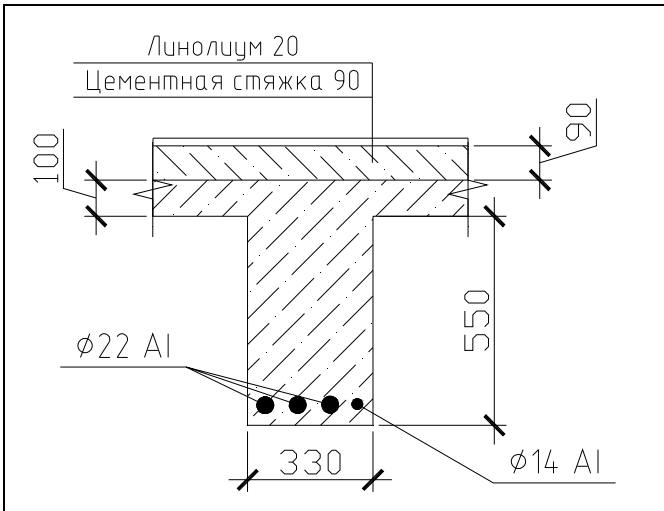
Главная балка ж/б перекрытия над четвертым этажом в осях «8-9/А-Б, В-Г»
